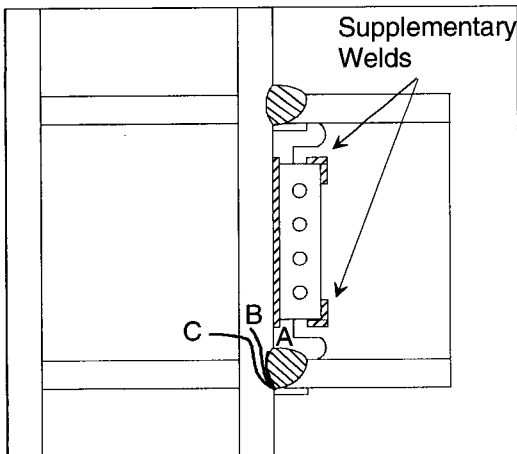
Welded flange-bolted web 강접합부 상세와 취성 파괴 양상
